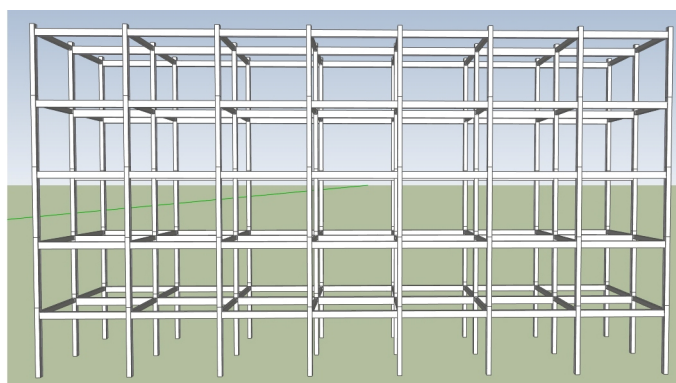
3D strutturale del parallelepipedo studiato
